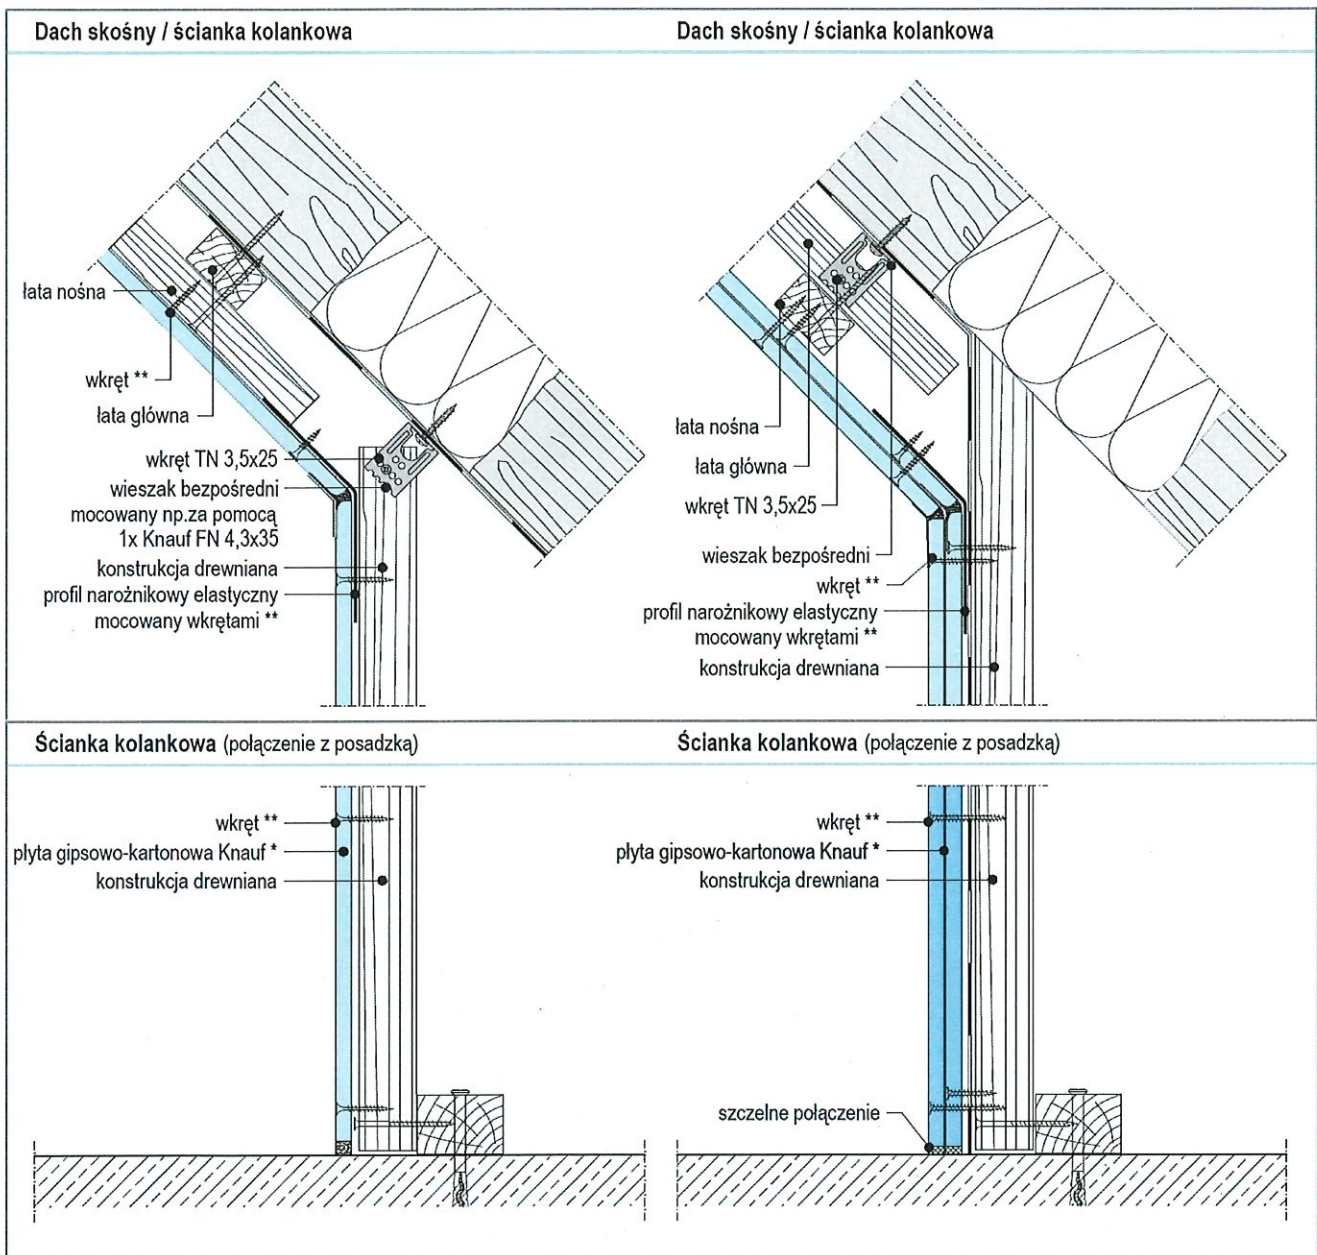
System D611.pl na konstrukcji krzyżowej, przekrój pionowy dachu spadzistego.
